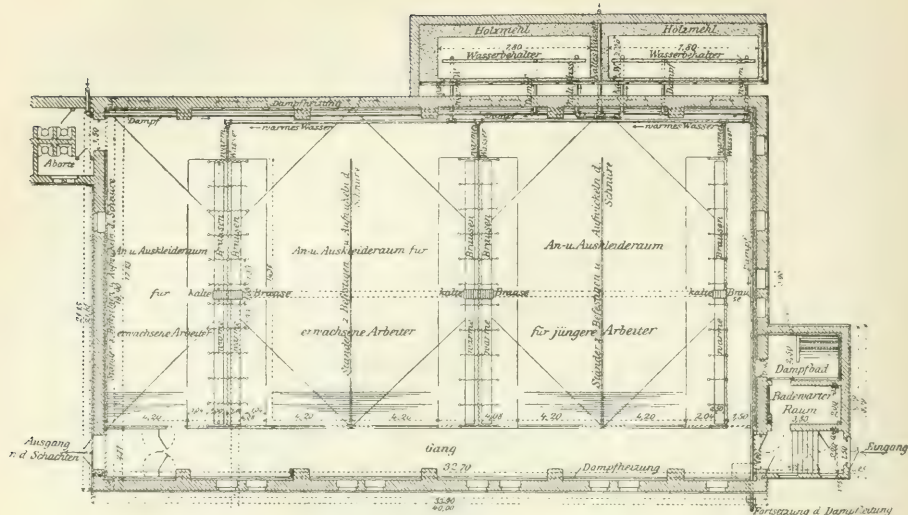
Brausebad auf Grube Dudweiler. Grundriß.
